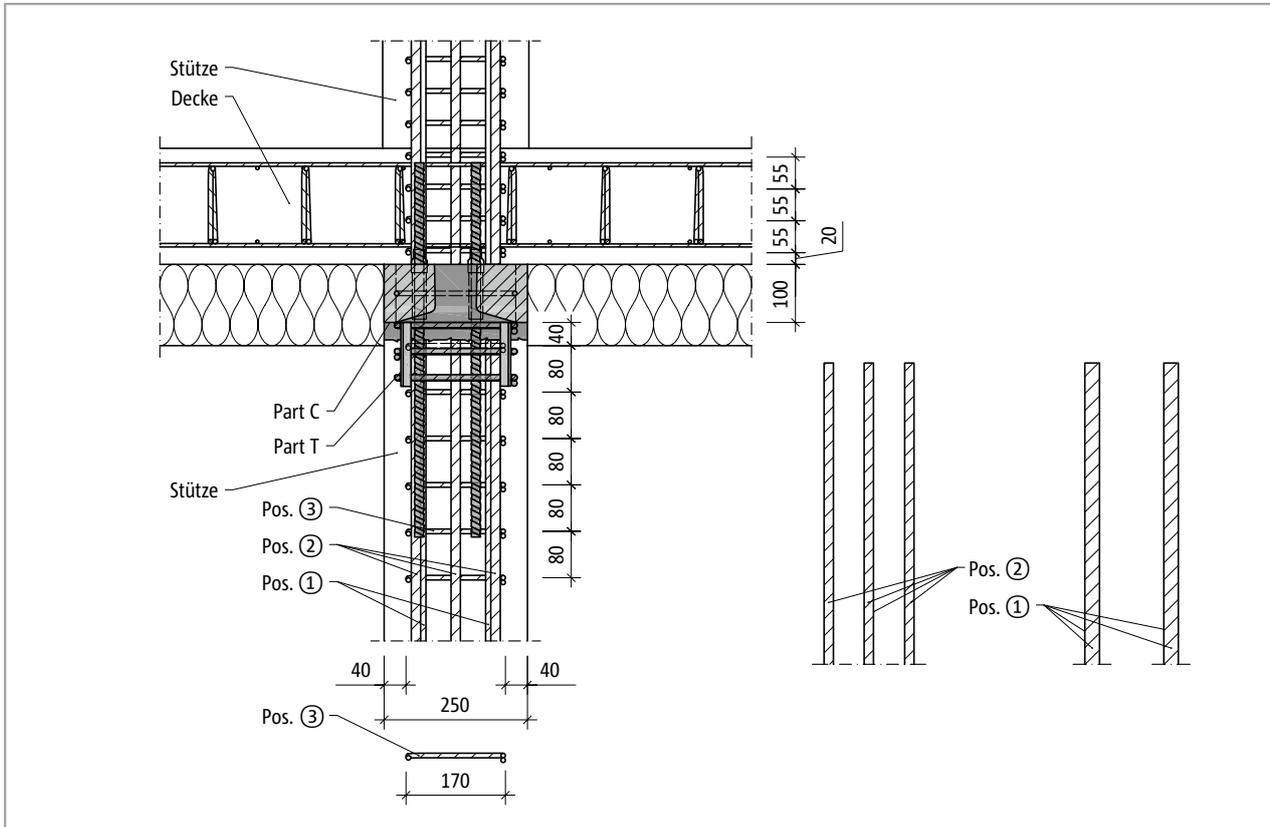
Schöck Scconnex® Typ P: Bauseitige Bewehrung im Stützenlängsschnitt A-A
